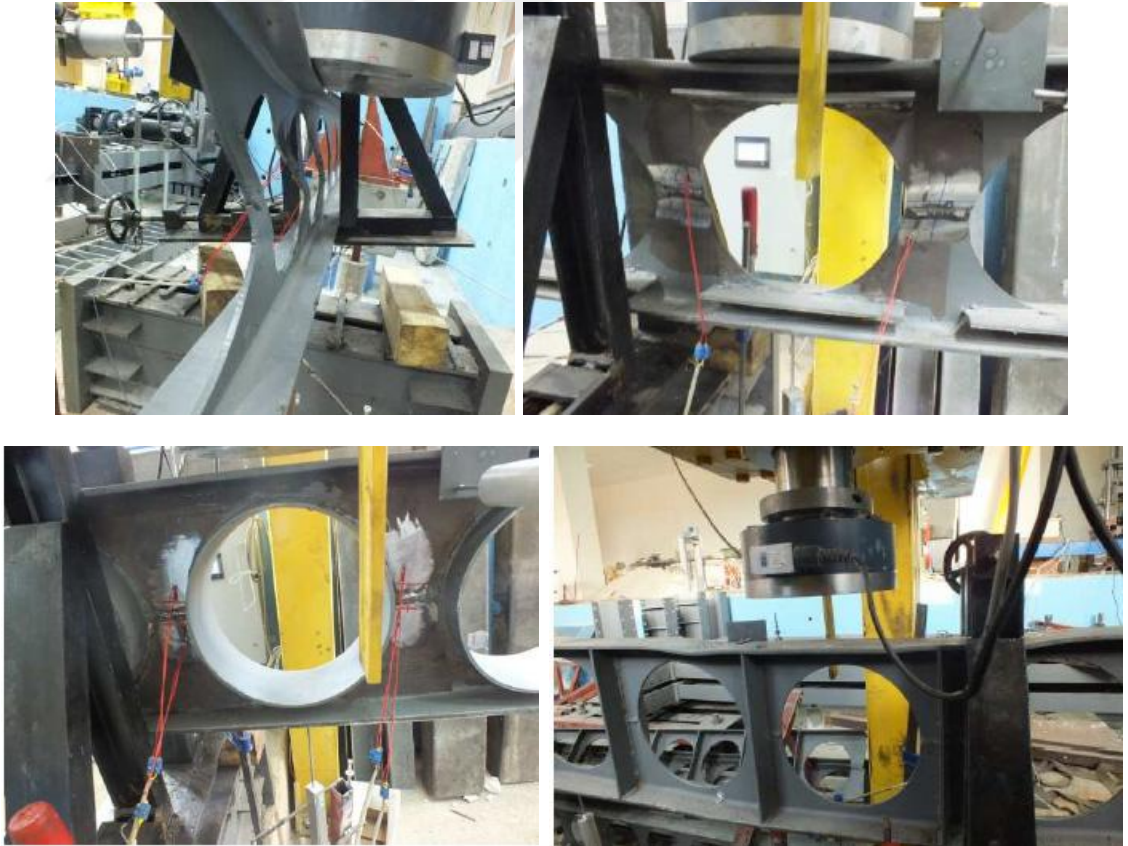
Demir yolu köprüsü kirişlerinde enine berkitme uygulaması [25]
